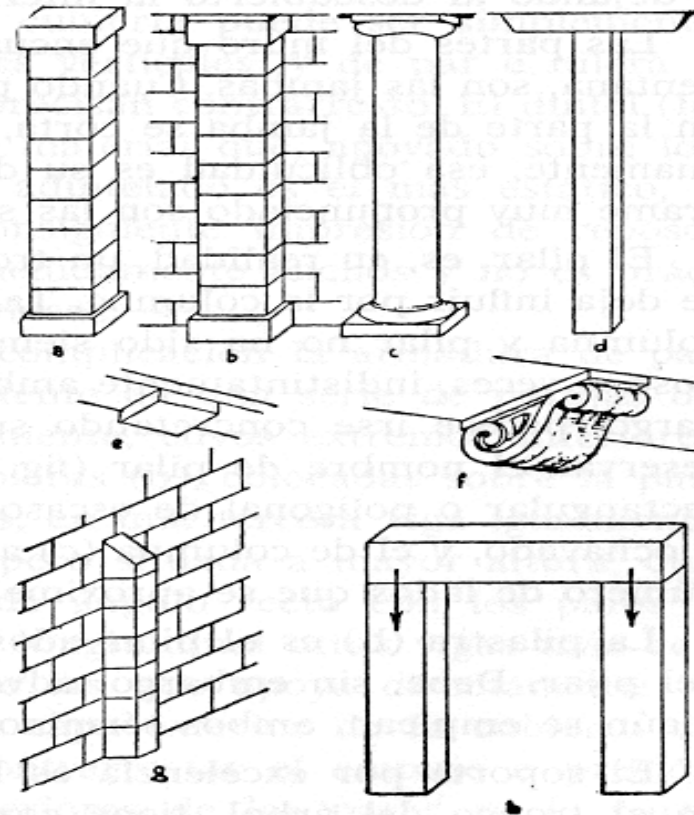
Soportes: a, pilar; b, pilastra; c, columna; d, pie derecho; e, f, ménsulas; g, estribo; h, dintel. (Argilés.)
